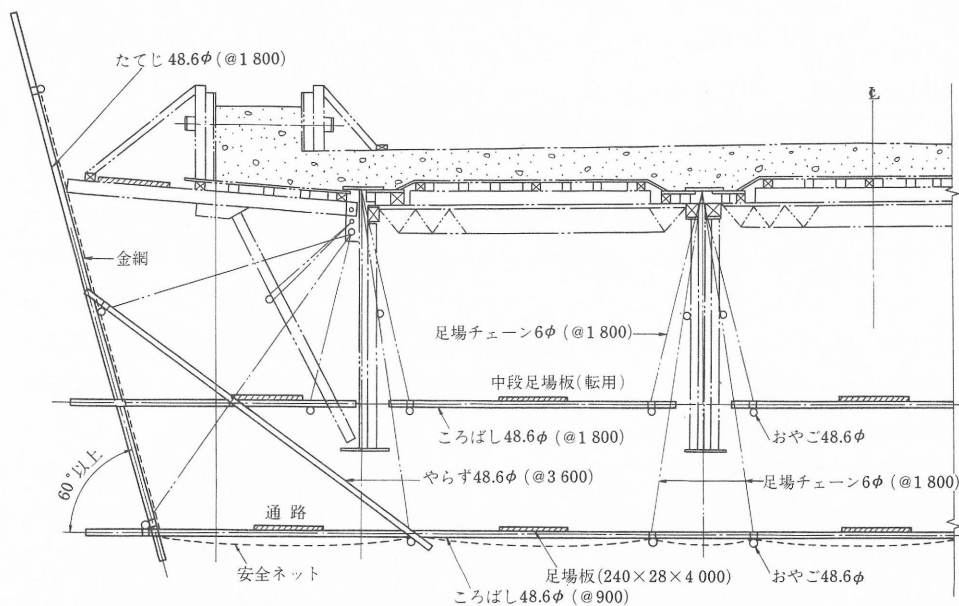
足場工の例 (日本橋梁建設協会・床版工事設計施工の手引き-S59.5より)
